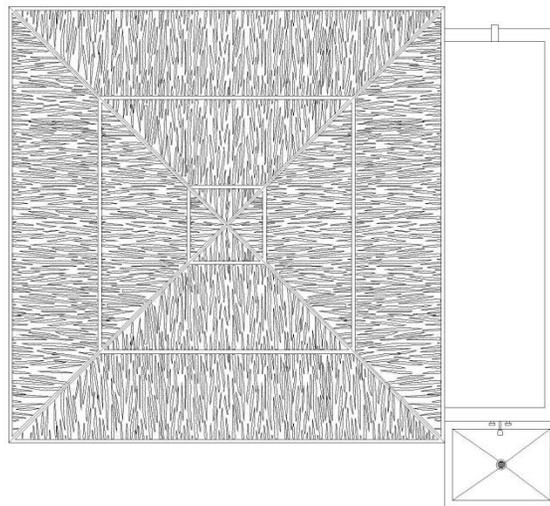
35. Planta Arquitectónica Planta de Azotea tipo del Kid's Club.
